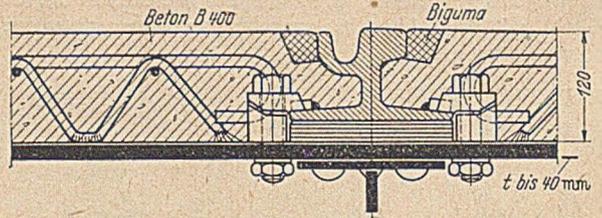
Fahrbahnplatte und Auflagerung der Straßenbahnschienen.
